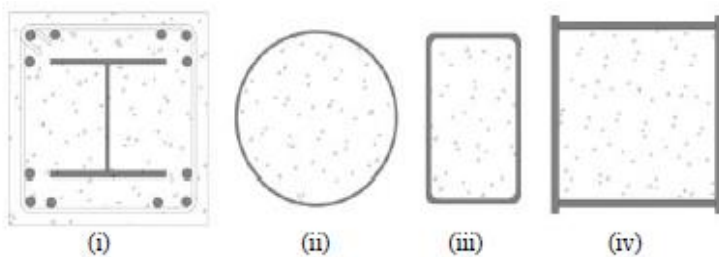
Columnas compuestas (NTCEM en revisión, 2014):
